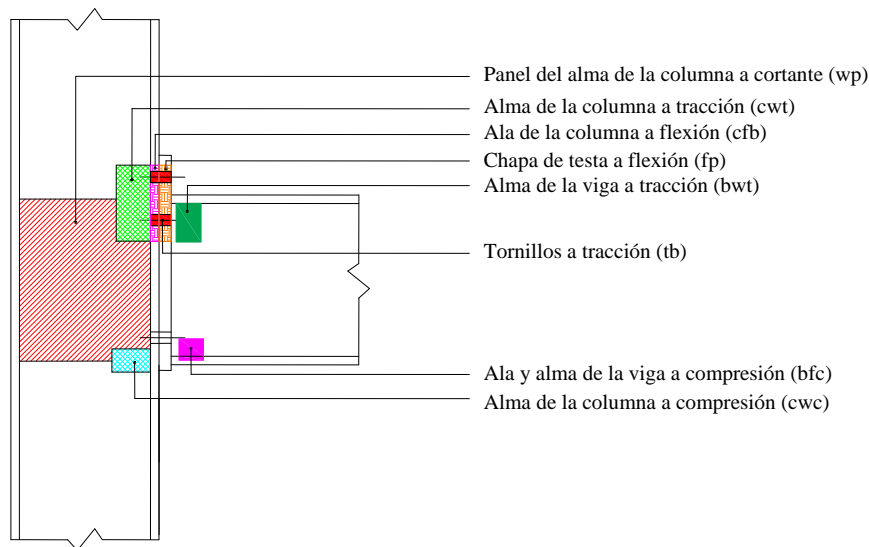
Componentes de una unión viga-columna con chapa de testa extendida atornillada al ala de la columna sin rigidizar.
